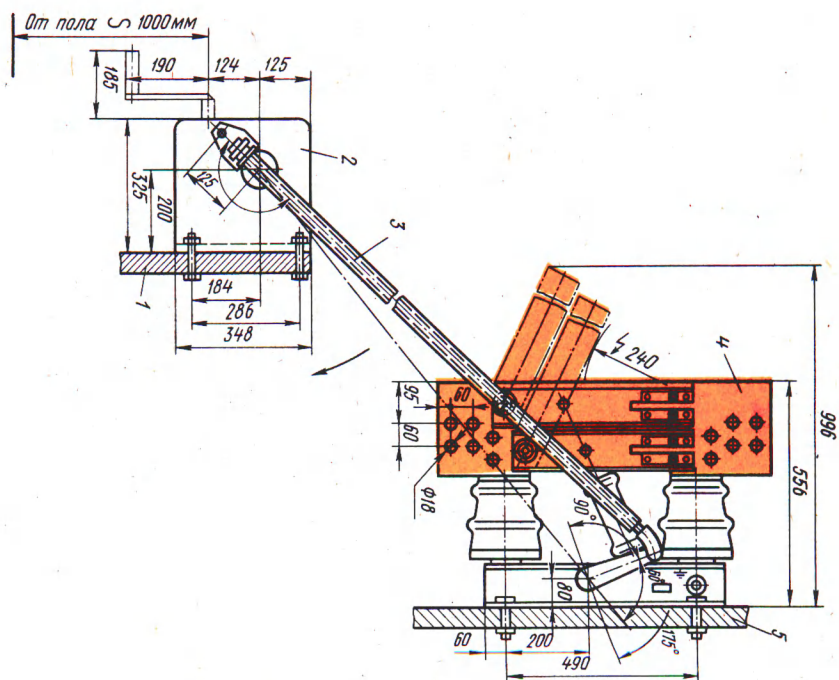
Установочный чертеж разъединителя РВК-20/7000
